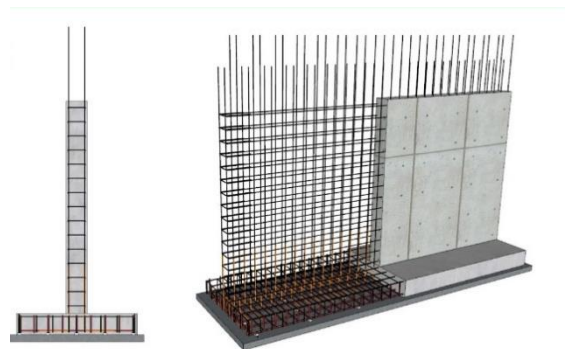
ferrailage d'un mur voile, source : ABC Maçonnerie
